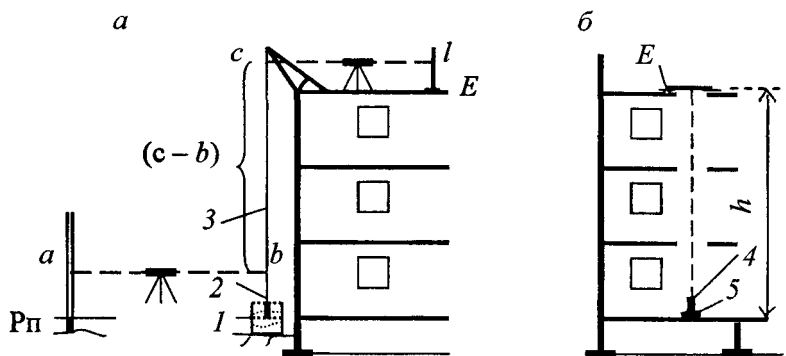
Передача отметки на репер E монтажного горизонта:
